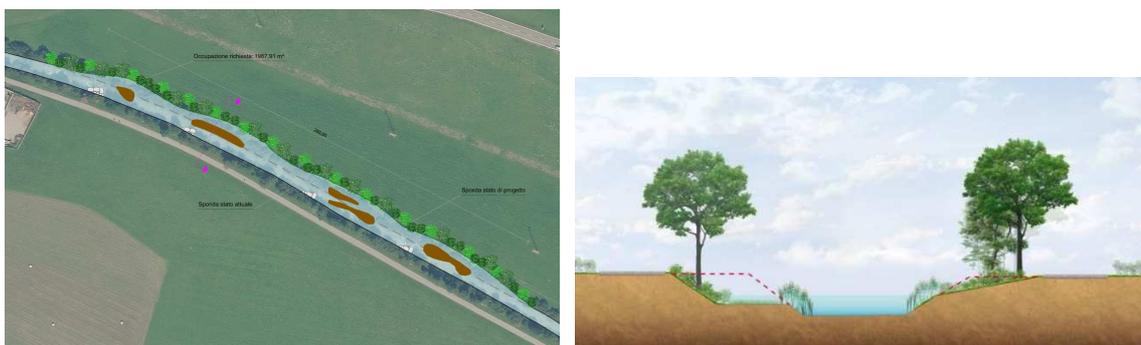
Rappresentazione planimetrica dell'allargamento progettato e sezione esemplificativa dell'allargamento (si veda anche la Tavola D-T-220-80-0) del Progetto Definitivo.
